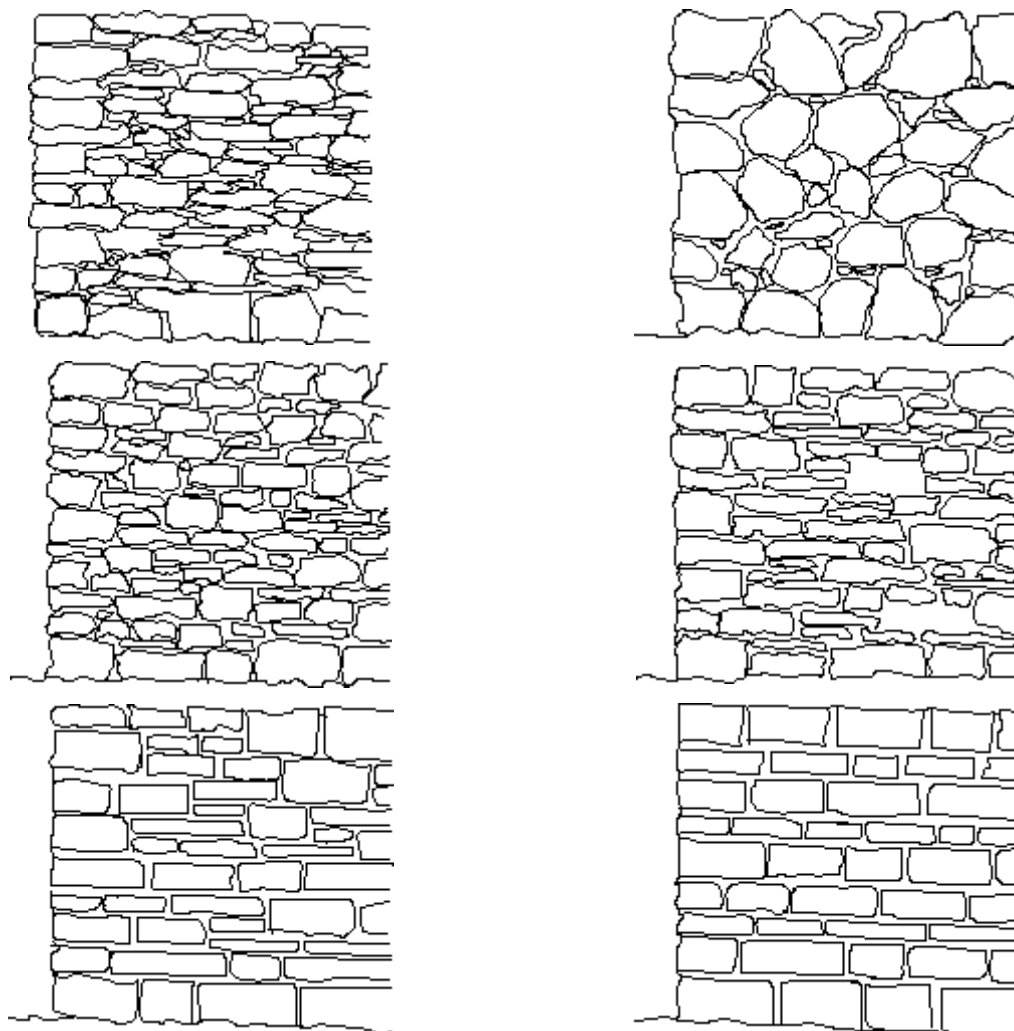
Примеры перевязок каменных кладок с использованием кирпича групп 2а и 2б
